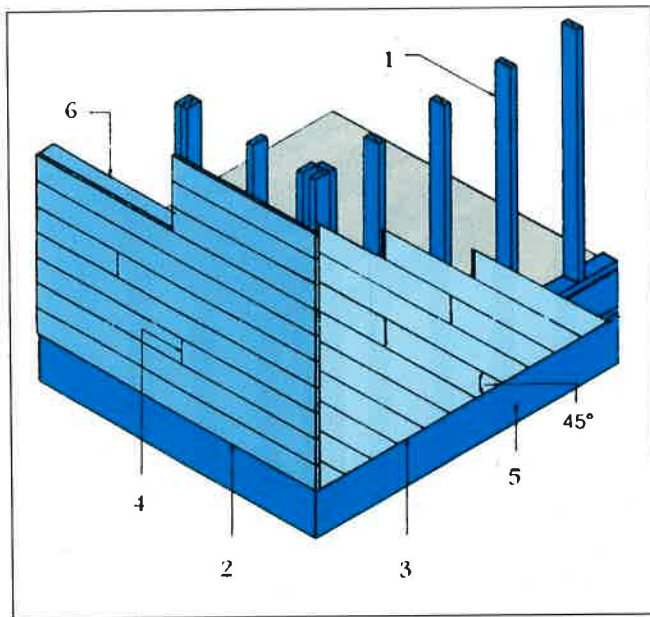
Trama estrutural revestida apenas exteriormente na vertical ou na diagonal. 1 - montante; 2 - aplicação horizontal; 3 - aplicação diagonal; 4 - junta; 5 - fundação; 6 - abertura para janela; 7 - viga de piso.
